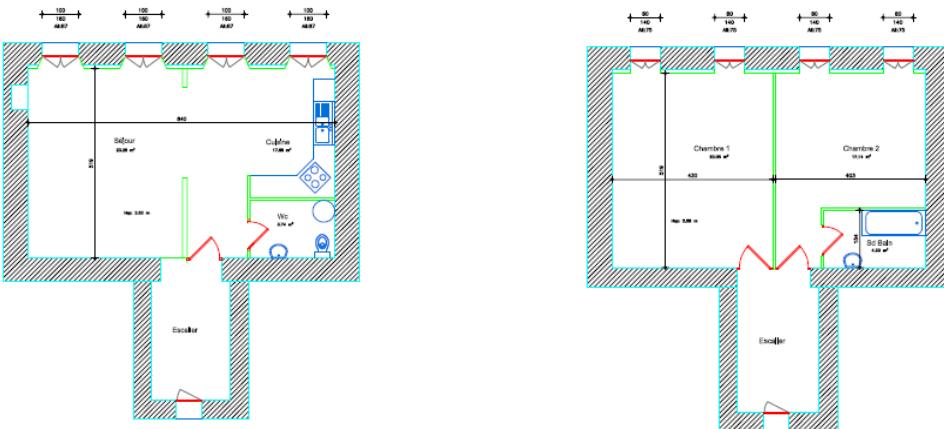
Plans du logement, de gauche à droite : R+2, R+3. Voir aussi annexe 2.
